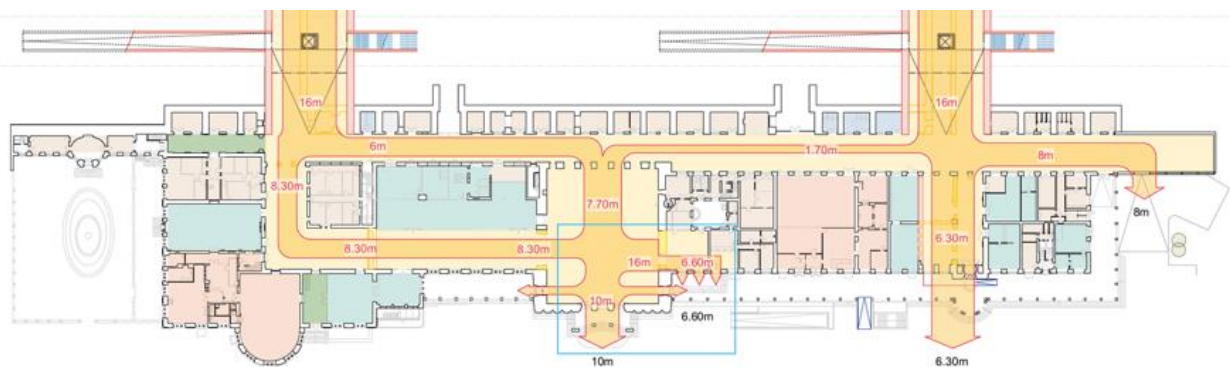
Grundriss Aufnahmegebäude mit Personenfluss und neuen Durchgangsbreiten
